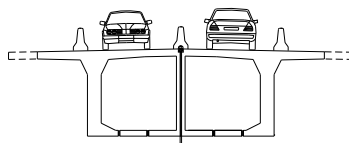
Fases constructivas de la conexión entre el la losa existente y la nueva losa.
